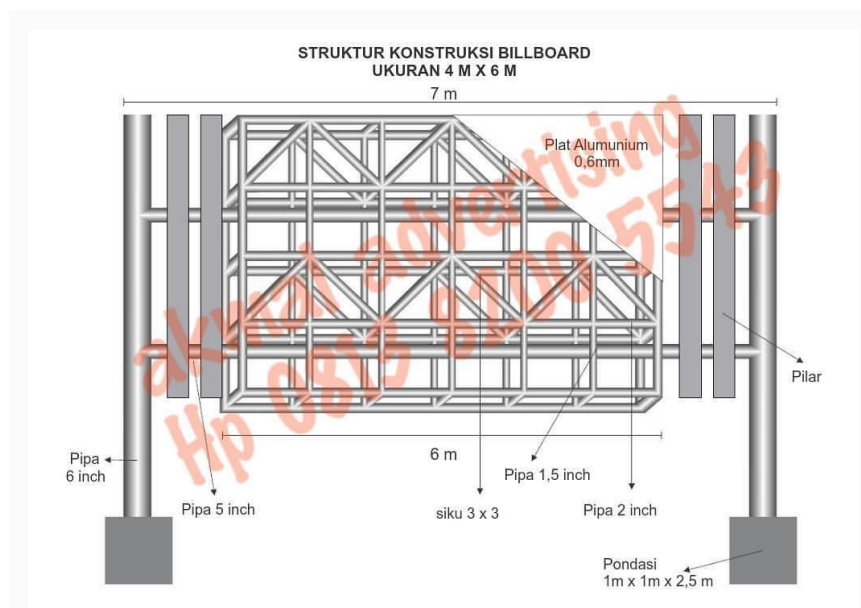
3 Konstruksi Papan Reklame Billboard/Baliho Horizontal
